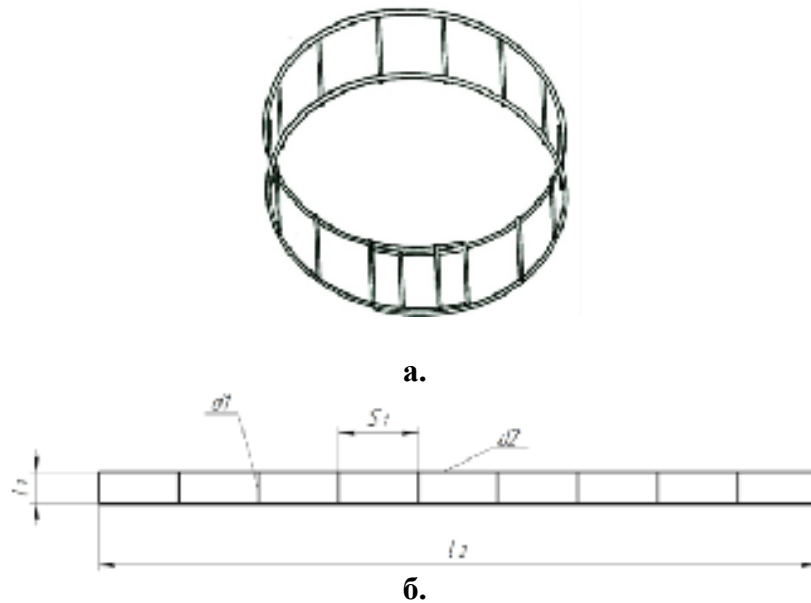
Общий вид (а) пространственной подпорки круглой формы и основные обозначения параметров плоского каркаса (б) для ее изготовления
